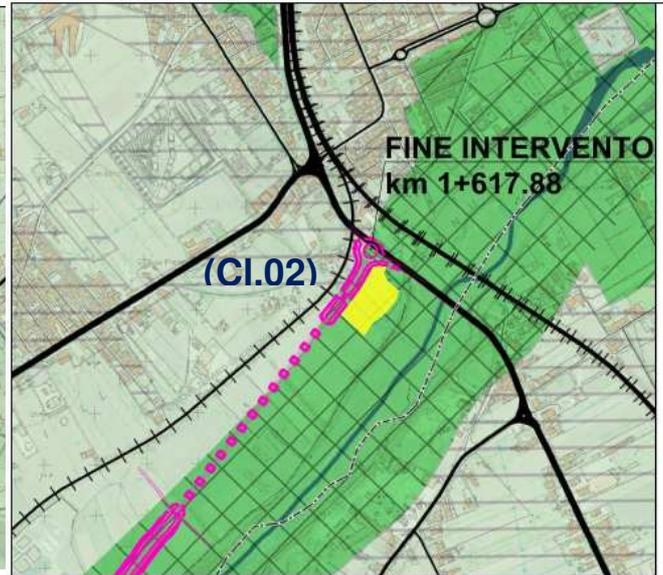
Dettaglio sovrapposizione Area Cantiere Logistico CL02
